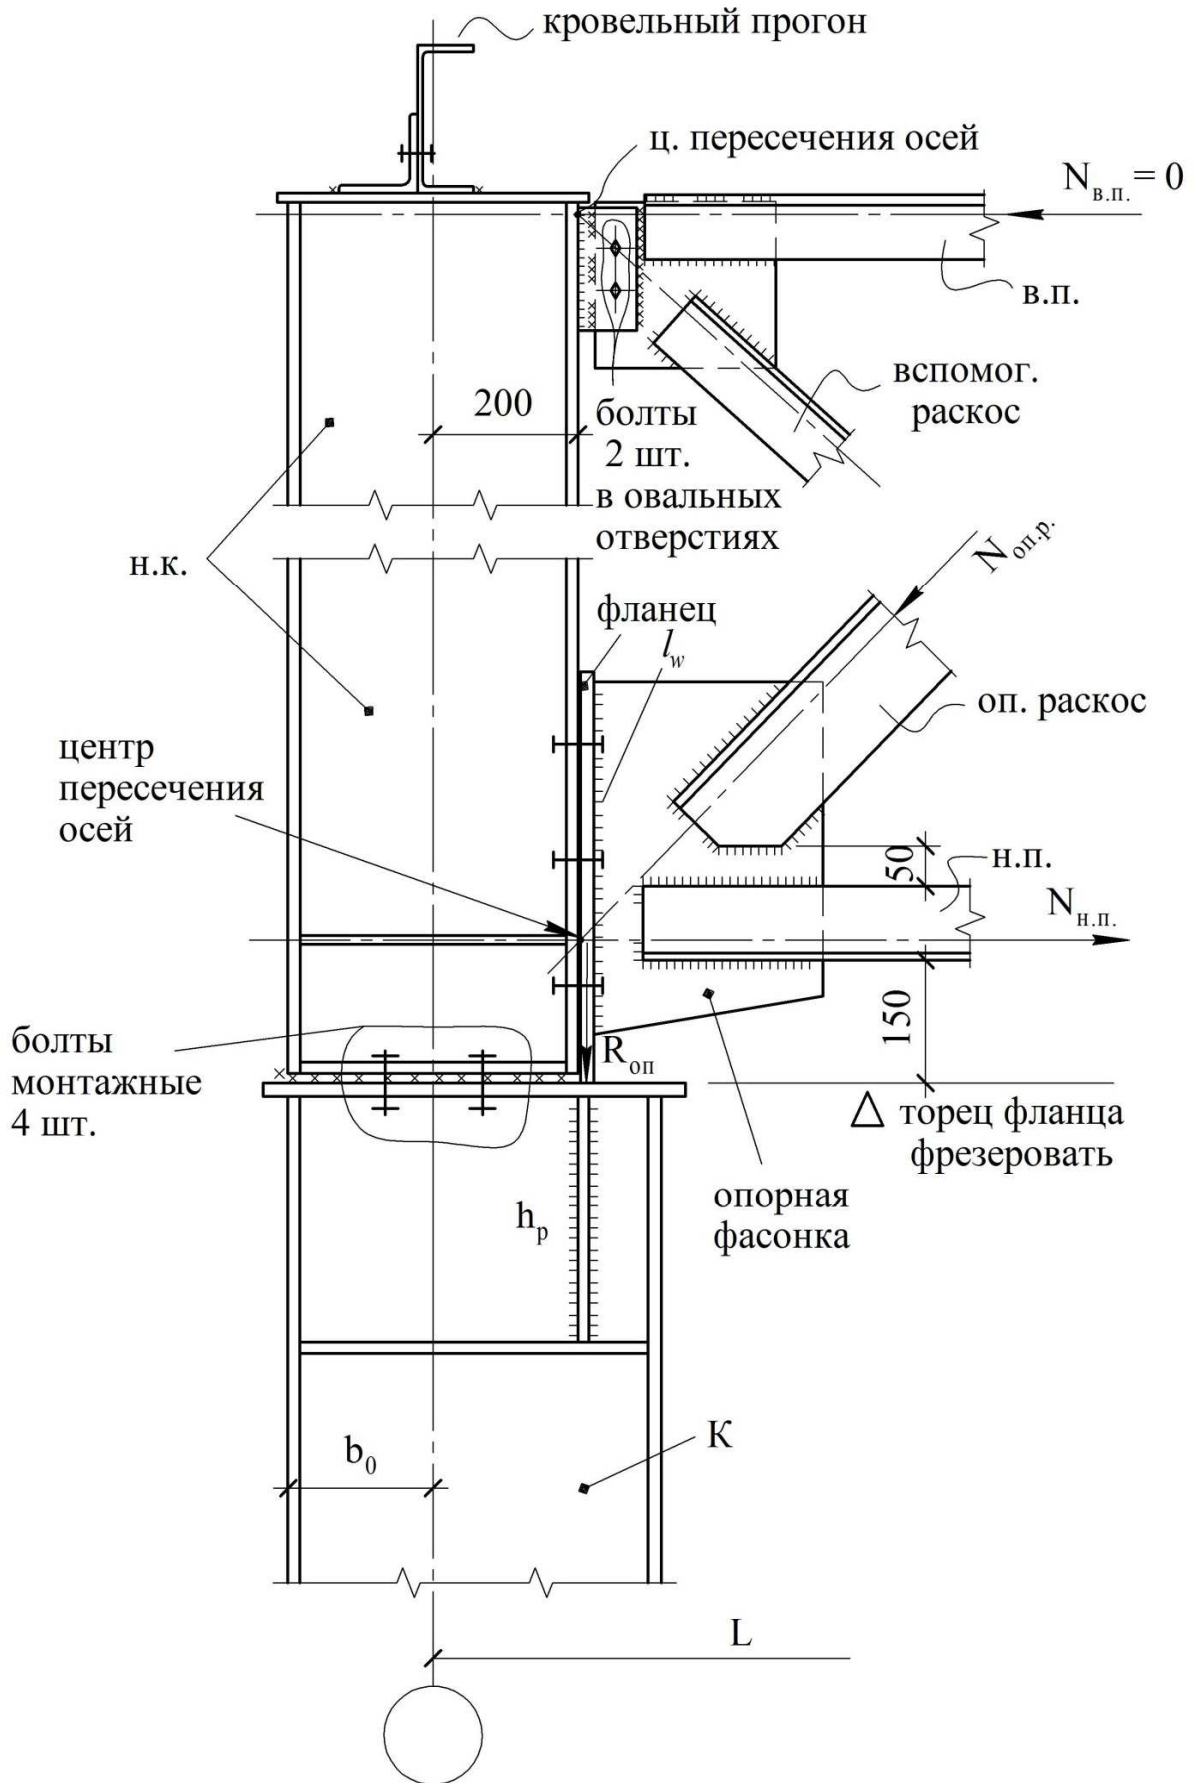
Шарнирный узел опирания ригеля на колонну
